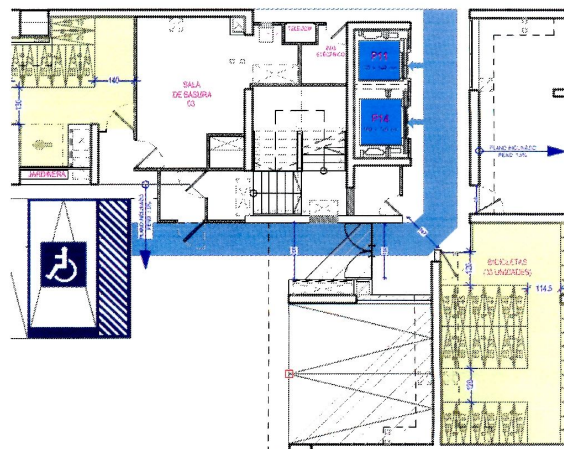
acceso oriente desde estacionamiento con ruta accesible universal
